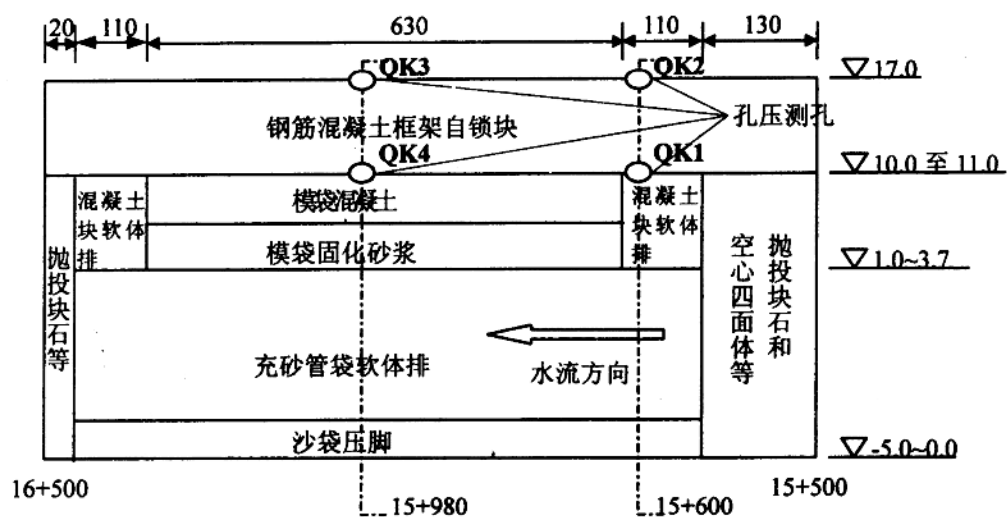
江新洲崩岸治理试验工程施工设计平面布置图(单位: m)
